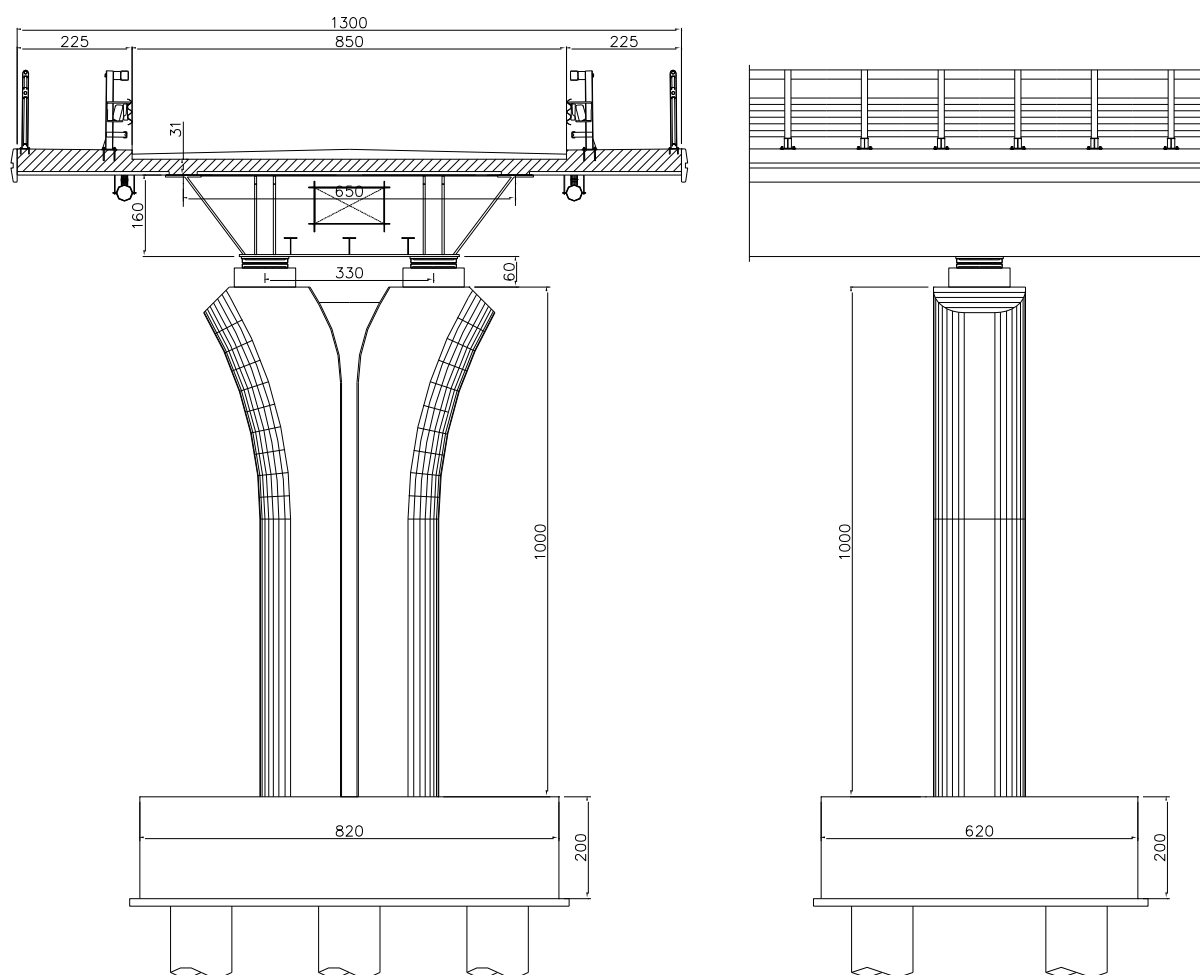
Prospetto frontale e laterale della pila con impalcato
